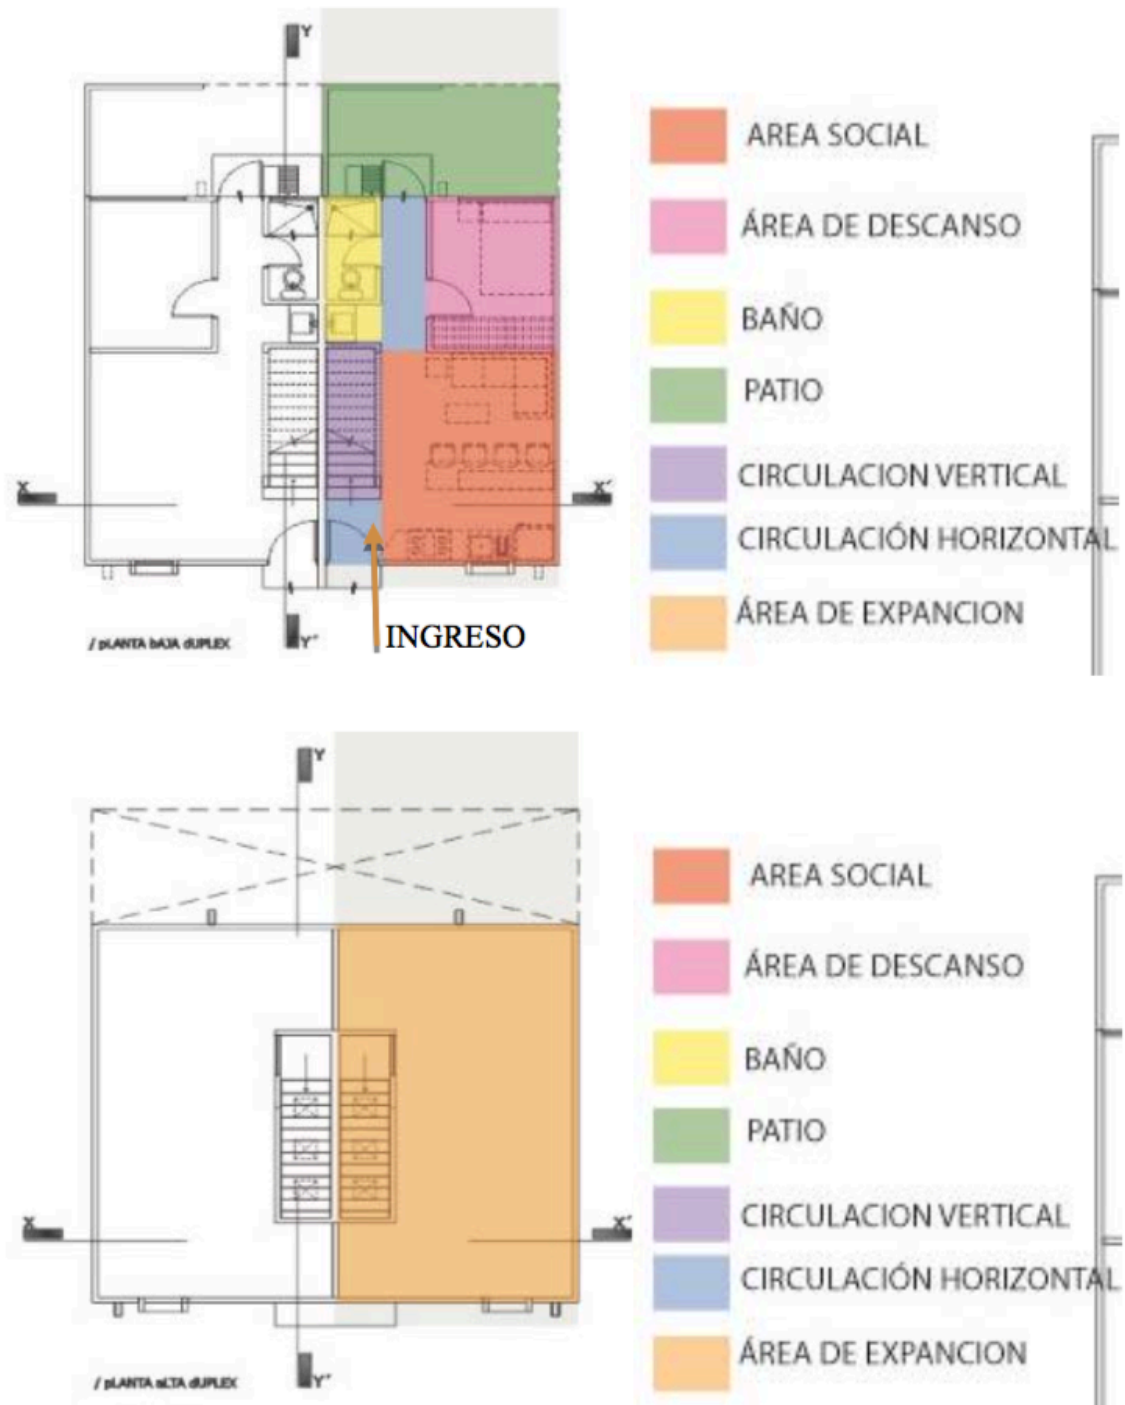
Casa Tipo A – Planta Arquitectónica
